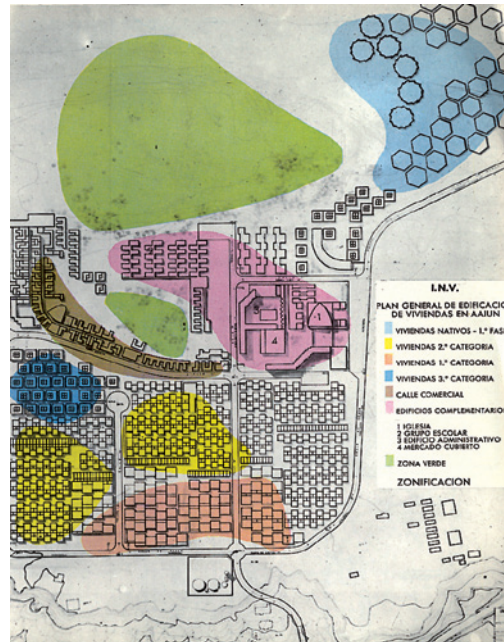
/ Planta de nuevo barrio en El Aaiún. Ramón Estalella, con la colaboración de José Serrano-Suñer y Juan Pedro Capote (1962)
